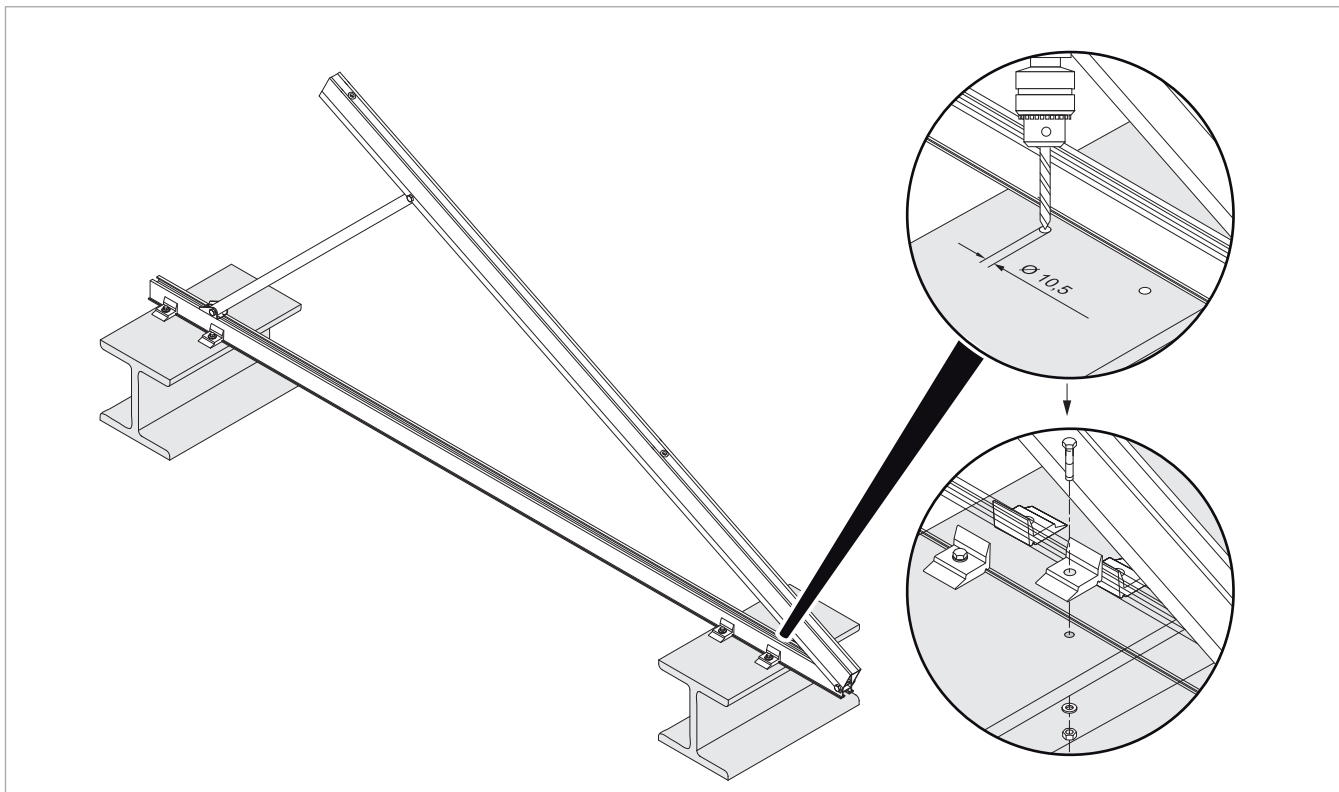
montagem do suporte para telhado plano sobre suporte de aço
